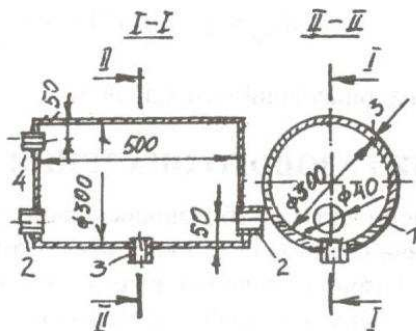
Протічний розширювальний бак атмосферного типу:
